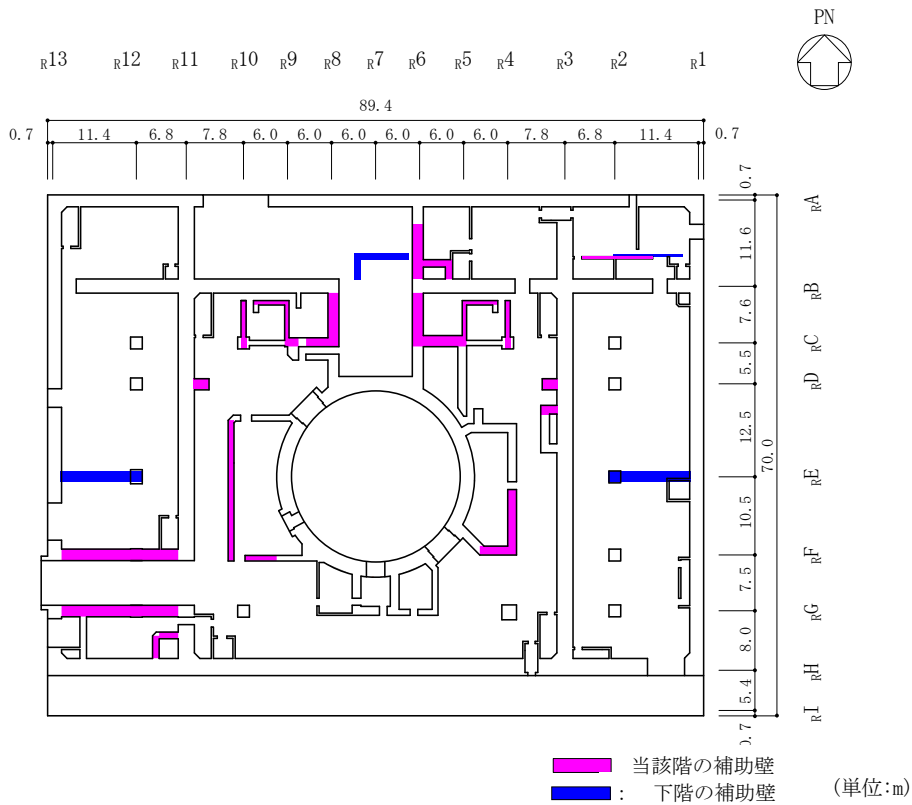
(2) 補助壁の配置図 (EL 15.3m)
